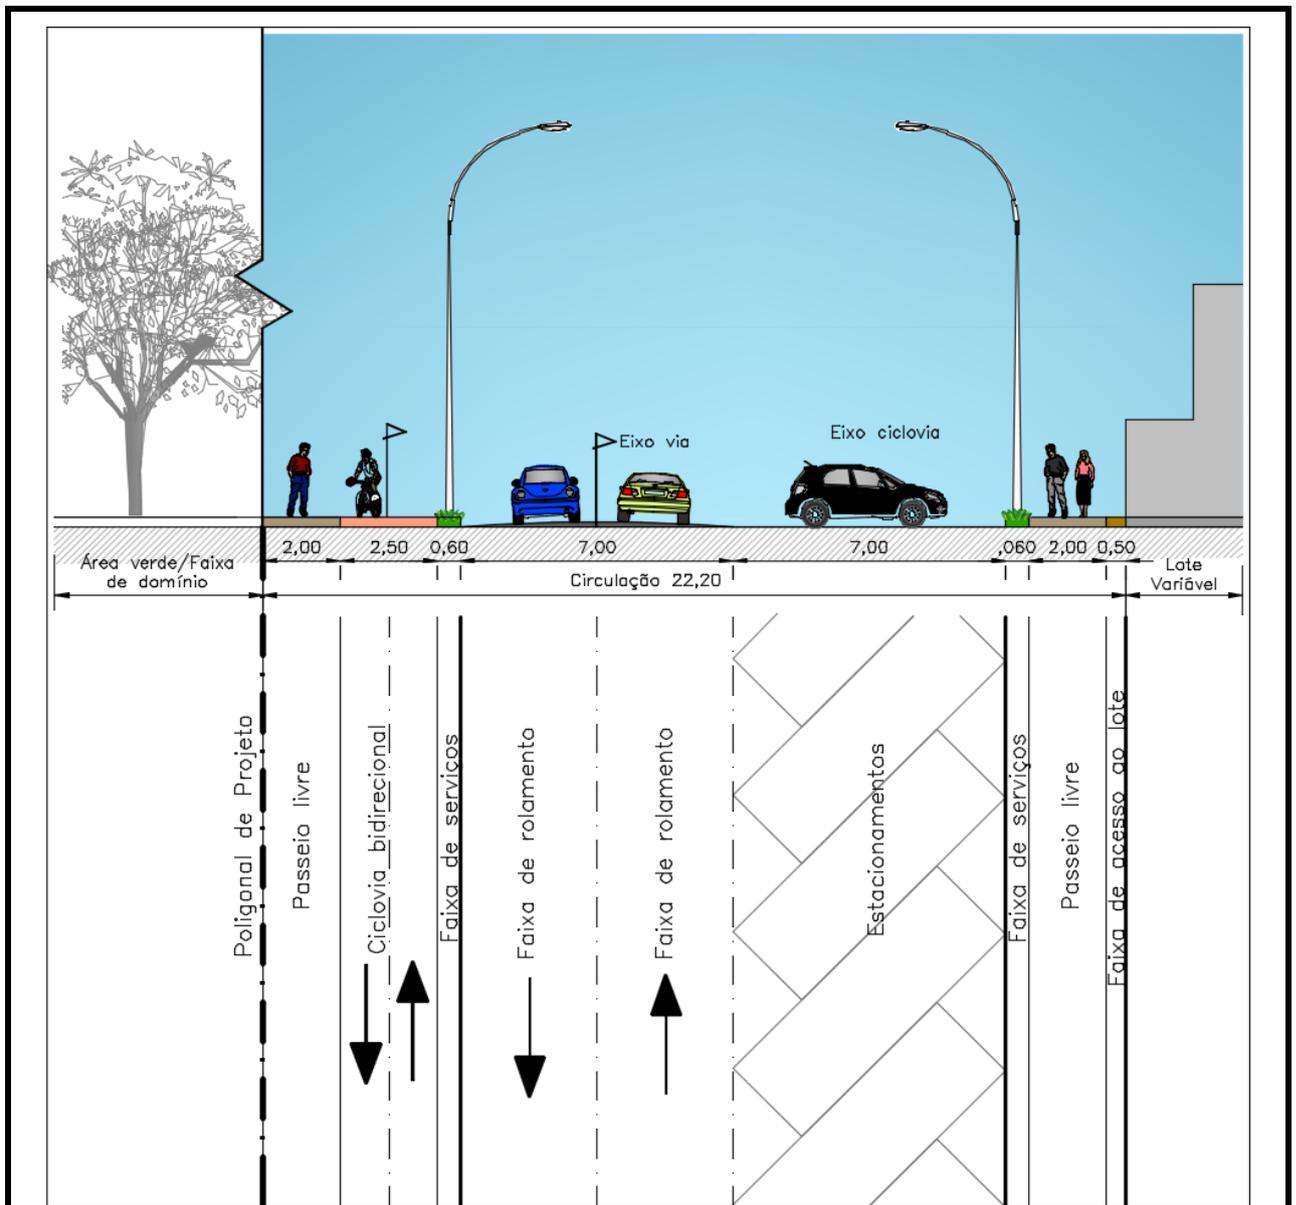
Perfil 04 - Via de Circulação de Vizinhança 1 (paralela à DF-290)
